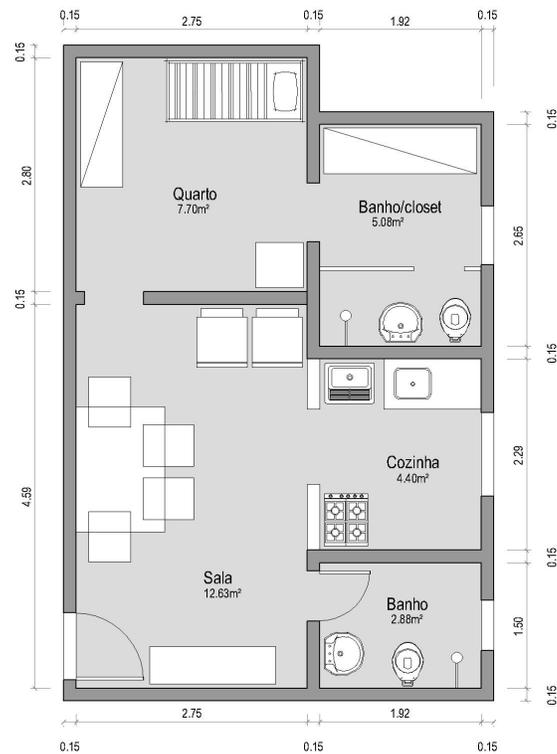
Planta baixa da casa da Sr. Rodrigo. Área: 32,69 m².
